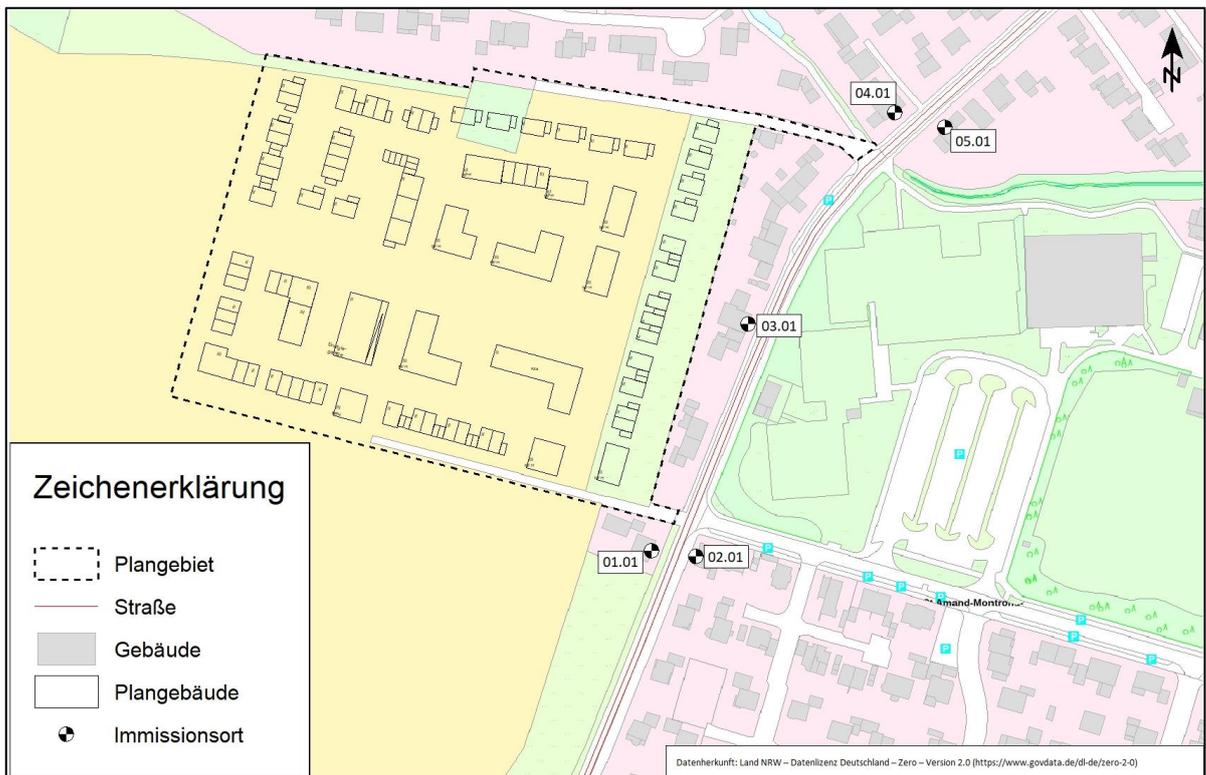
Übersichtslageplan mit Darstellung der betrachteten Immissionsorte
